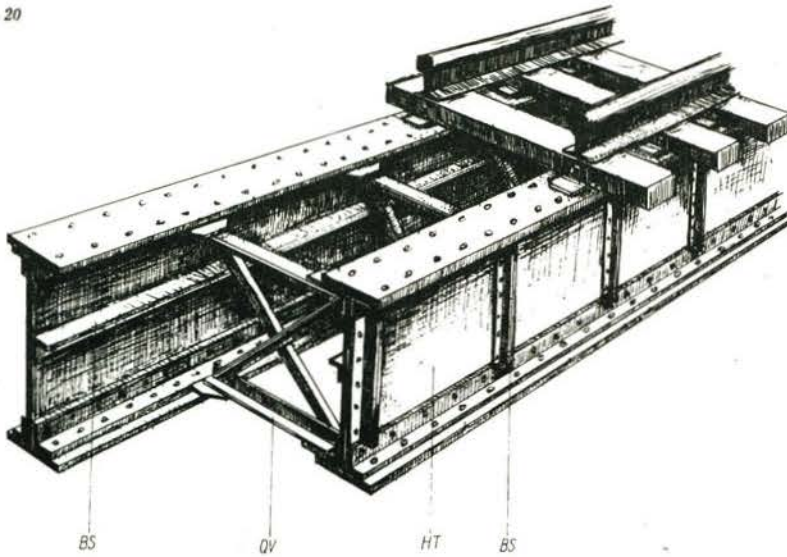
Deckbrücke aus genieteten I-Trägern. Zur Beulsicherung sind außen L-Profile und innen ein waagerechtes L-Profil aufgenietet. Die Verbände bestehen aus L-Profil. Die Schwellenbefestigung erfolgt auf dem Obergurt der Hauptträger mit Schwellenwinkeln.
